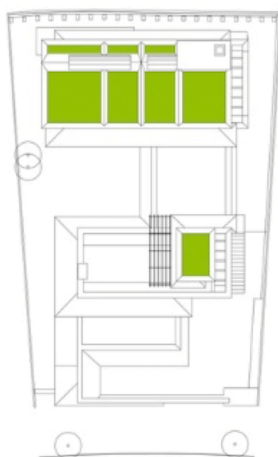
| Croqui do projeto Casa na Lapa, de Brasil Arquitetura
